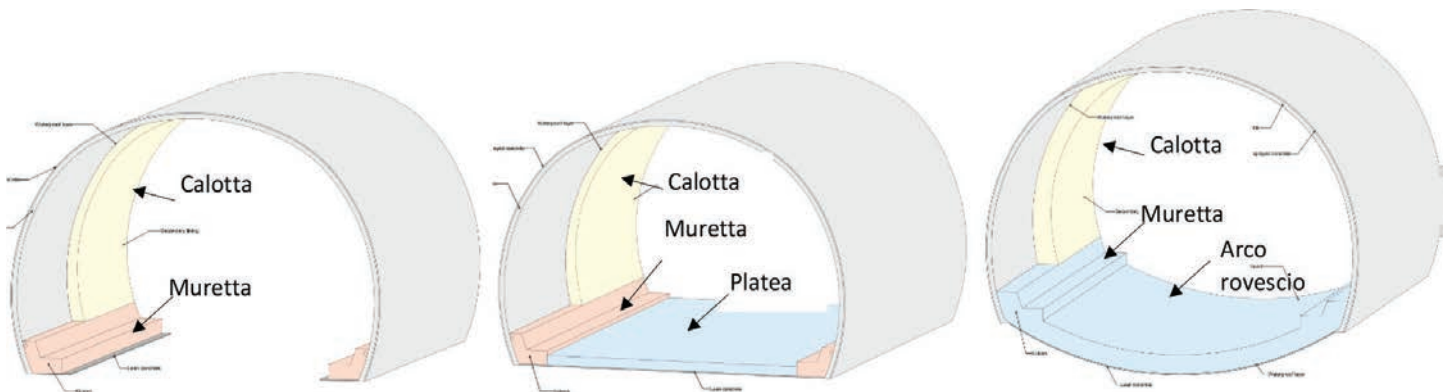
(a) Sezione aperta; (b) sezione chiusa drenata; (c) sezione chiusa impermeabilizzata (nella Motza).
